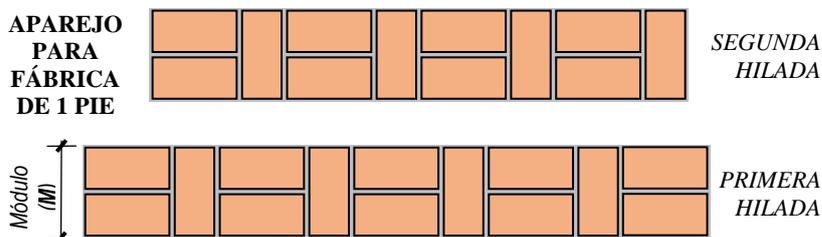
Vista en planta de un aparejo gótico simple en una fábrica de 1 pie
